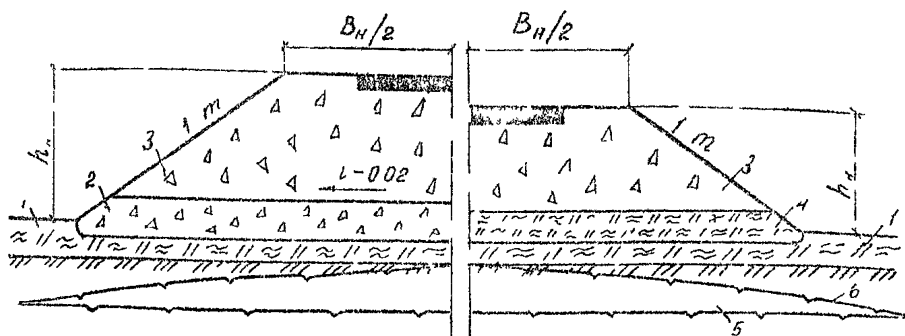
Поперечные профили насыпи на льдонасыщенных грунтах: I – мохорастительный покров; 2 – защитный слой из пренирующего грунта мелких фракций; 3 – несцементированный обломочный грунт; 4 – теплоизоляция из мха (чащеваются на основе теплового расчета); 5 – ВГМ до постройки насыпи; 6 – ВГМ после постройки насыпи
